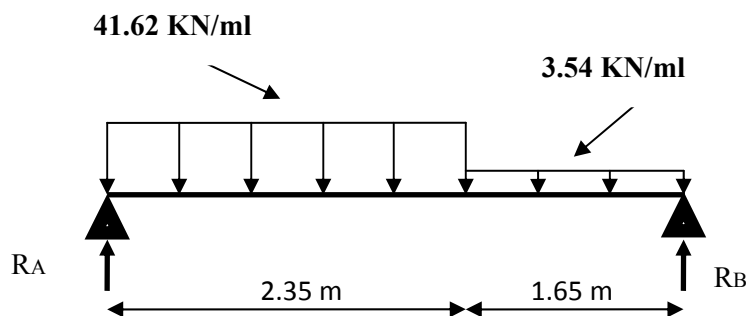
Schéma statique de la poutre palier à L'ELU
